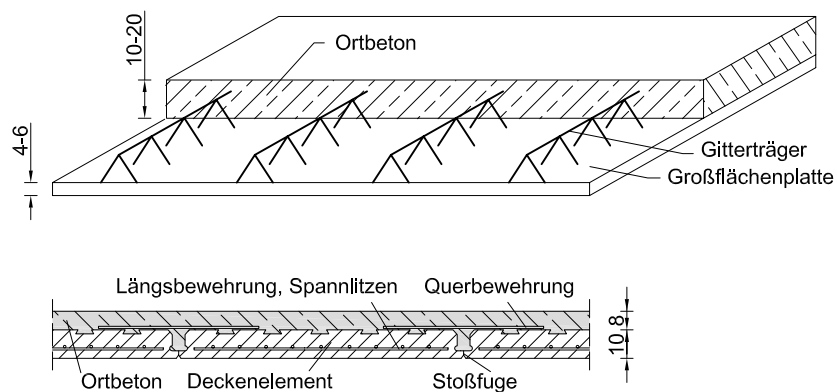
Elementdecke und vorgespannte Elementdecke [34]
